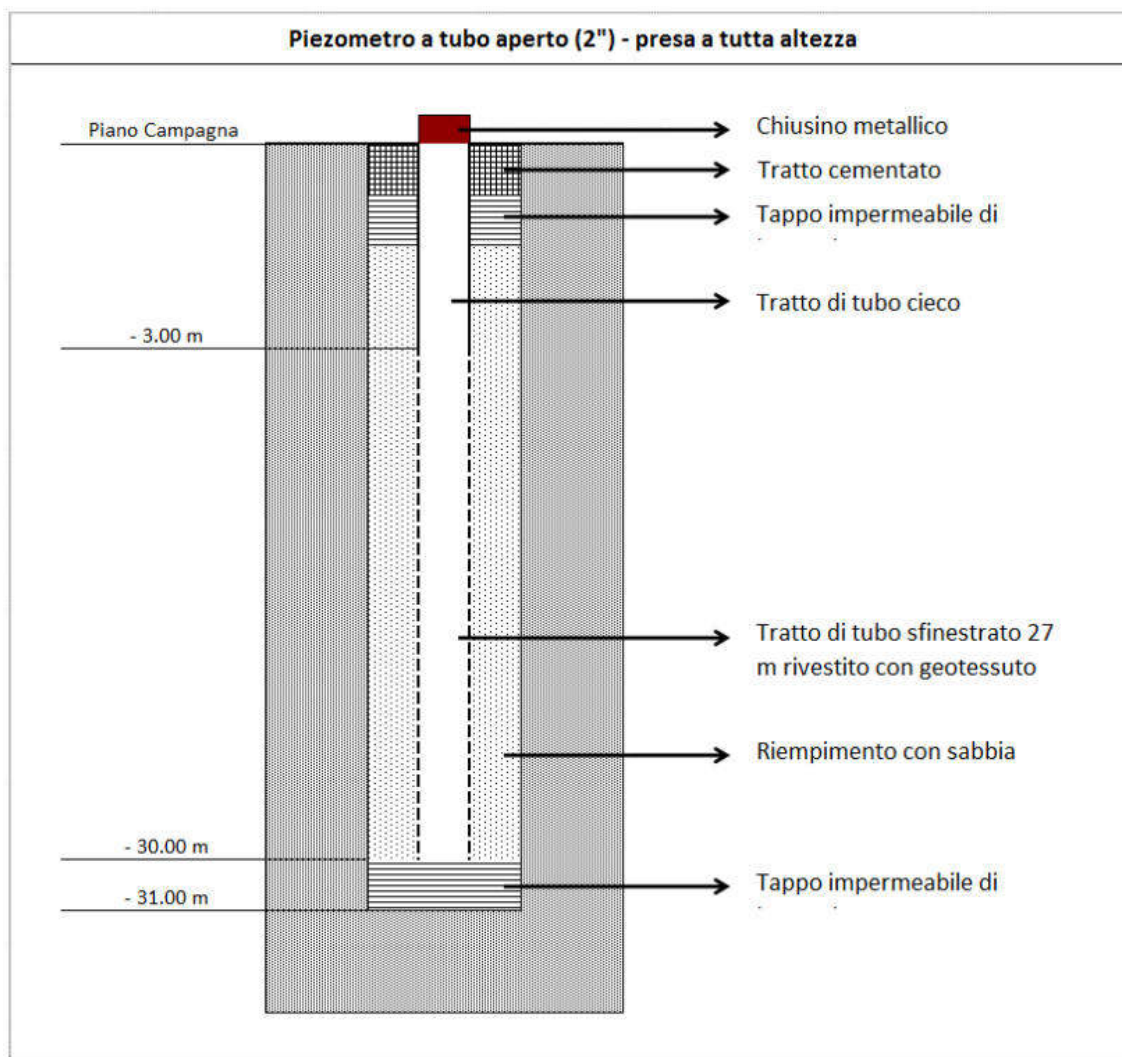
Indagini Geognostiche (2018) - Schema Piezometro Installato nell'Area di Progetto (Sondaggio BH1)
